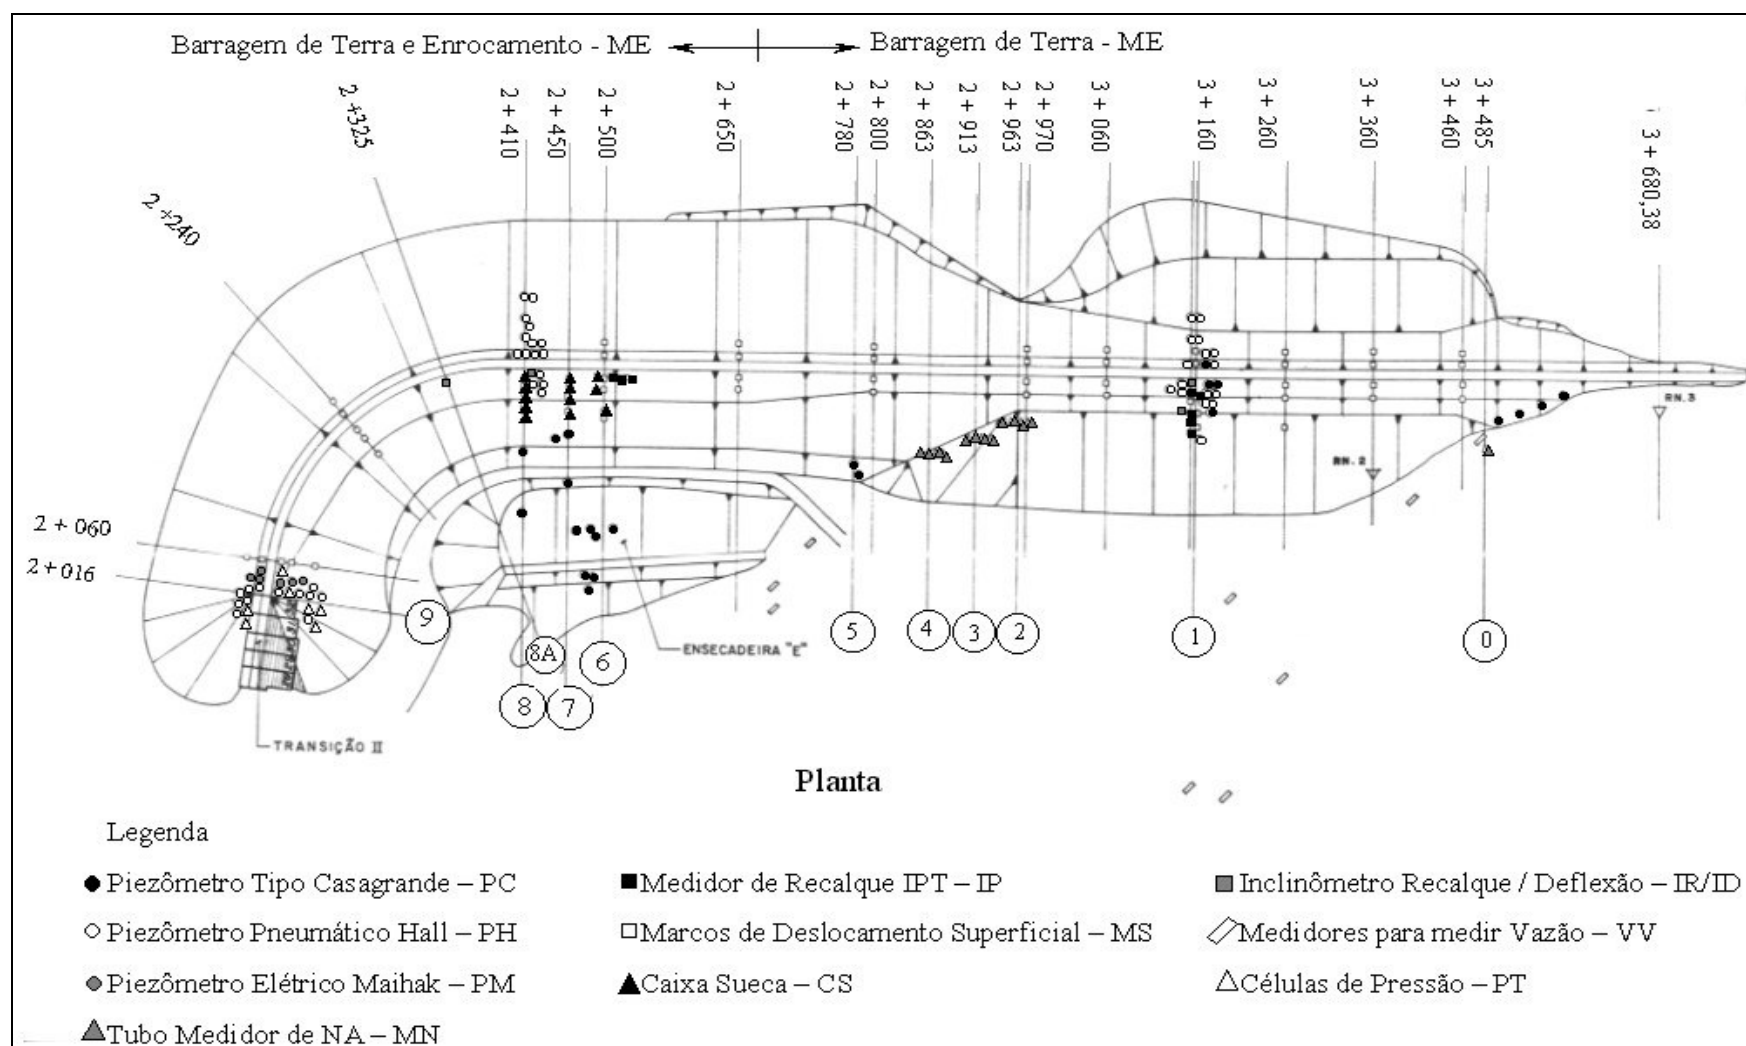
Planta da Instrumentação Instalada na Barragem de Terra e na Barragem de Terra e Enrocamento da Margem da UHE São Simão
